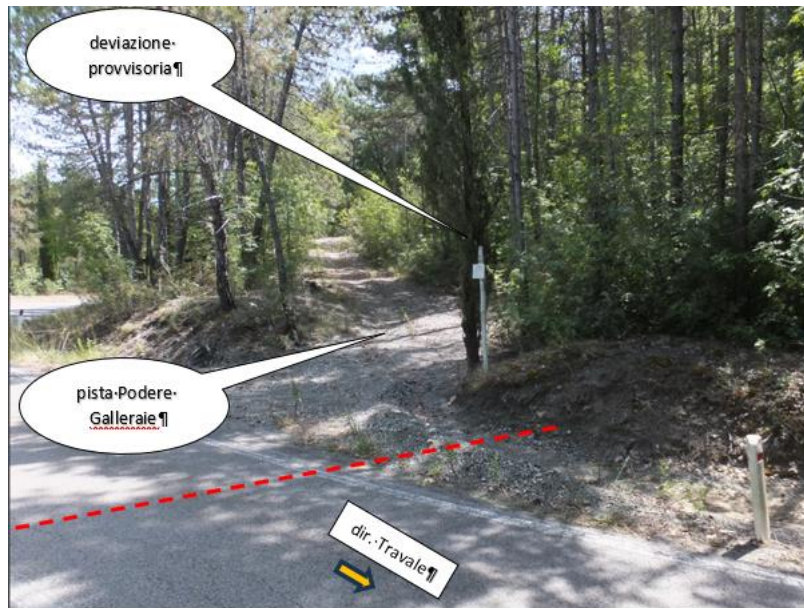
diramazione della pista di accesso a "Podere Galleriaie" dalla S.P. 3
